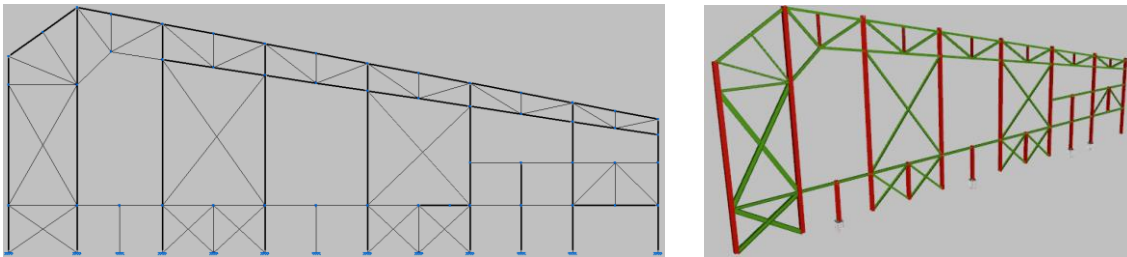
CYPE 3D – Pórtico de fachada oeste.
